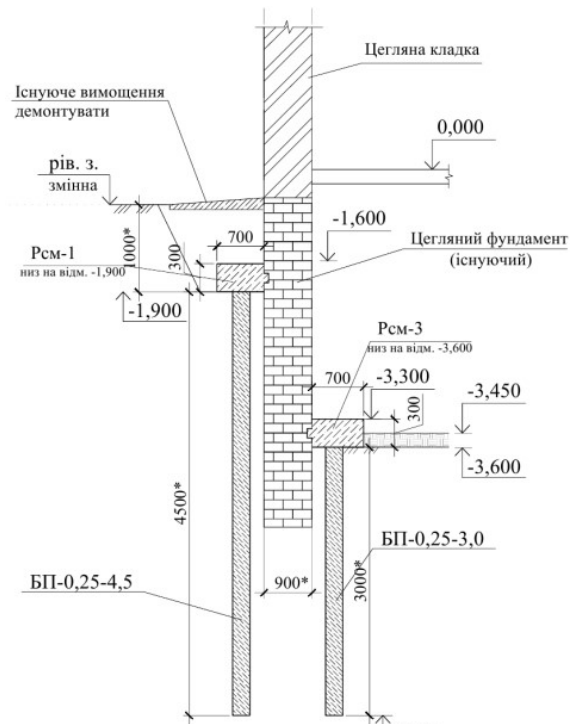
Схема «пересадки» будівлі на буронабивні палі
